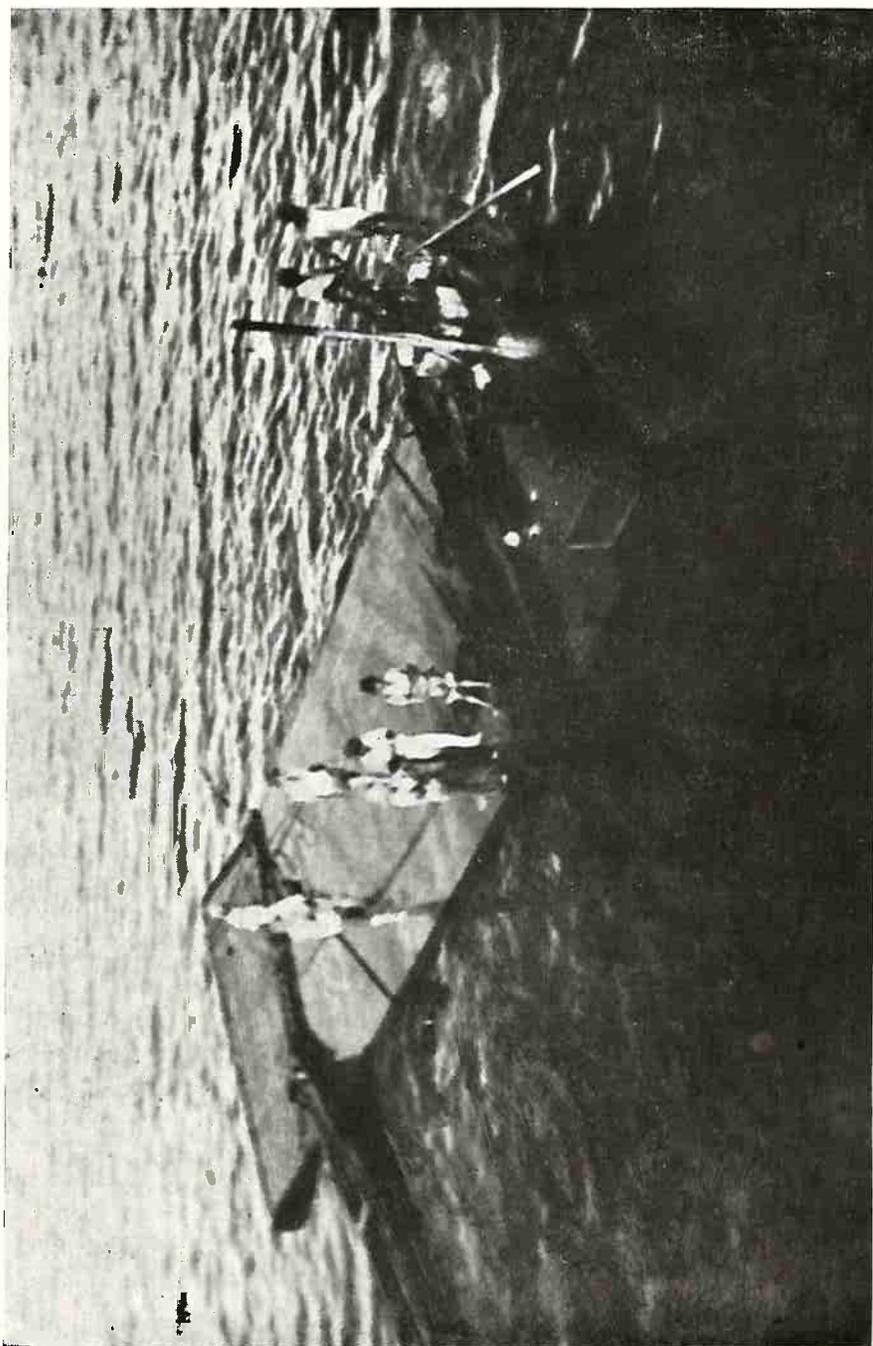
a — Transporte por flutuação do caixão pilar da ponte Laranjeiras.
